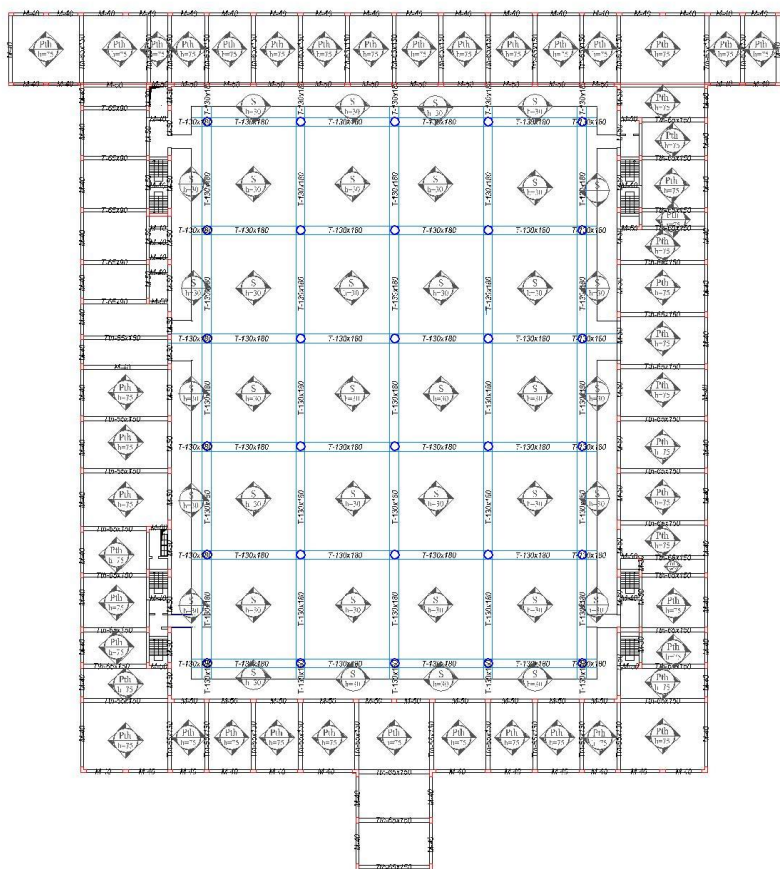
Plani i kolonave dhe strukturave ne kuoten -7.75 m
